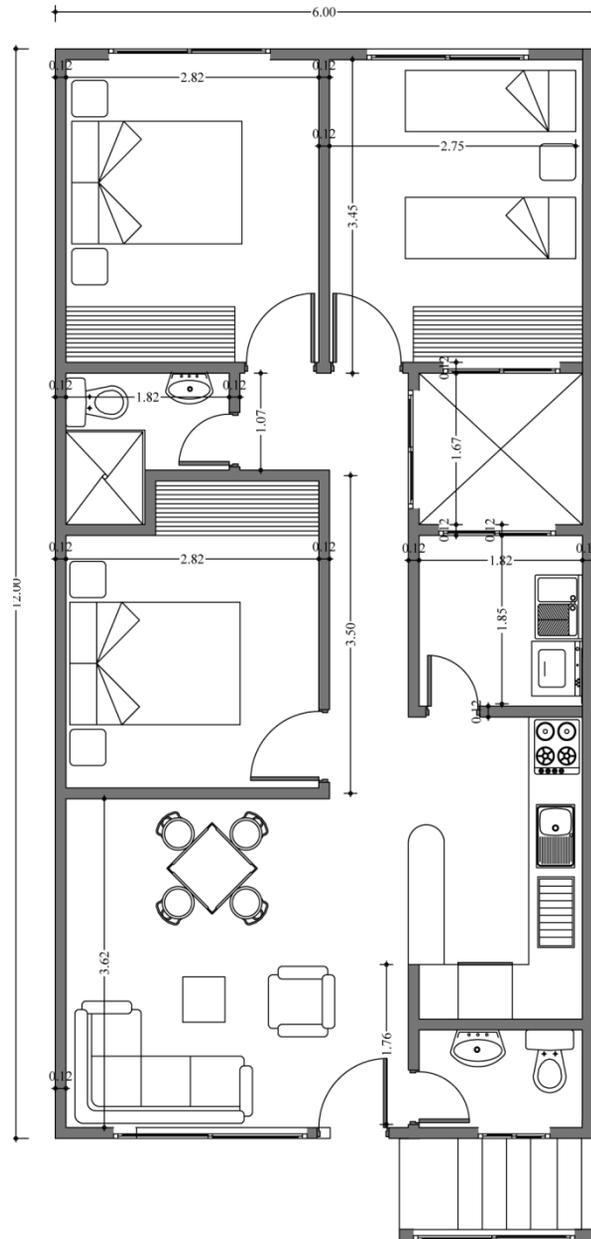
Planta arquitectónica primer piso vivienda trifamiliar
